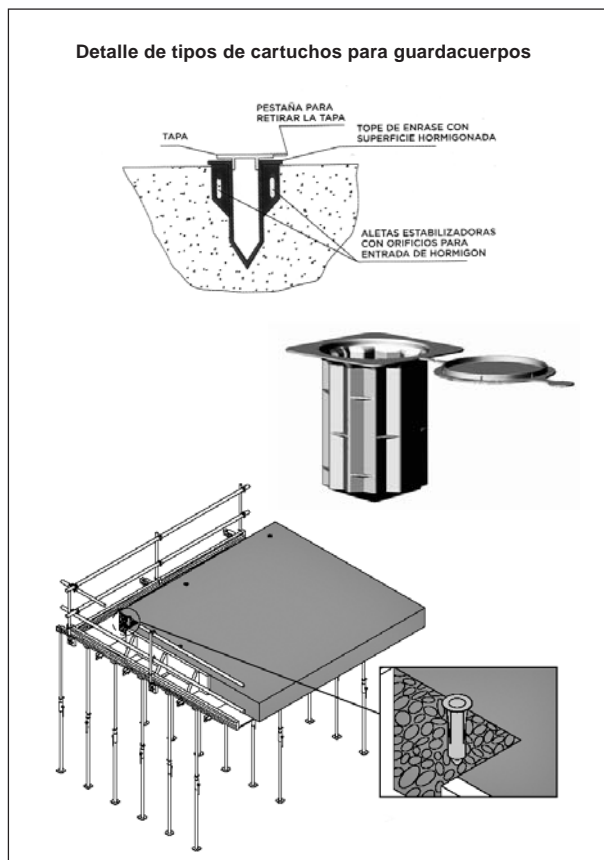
Sistema de fijado al forjado mediante cartuchos. Detalle de la colocación del taco de forjado
